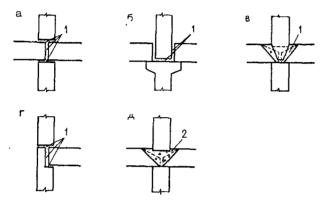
Горизонтальные стыки внутрениях несущих стен с перекрытиями
